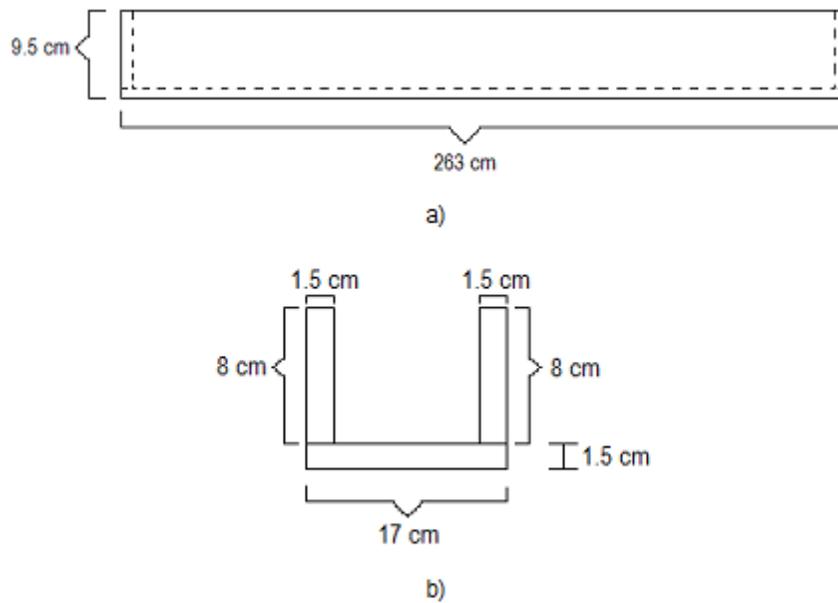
a) Parte lateral del molde, b) Parte frontal del molde
